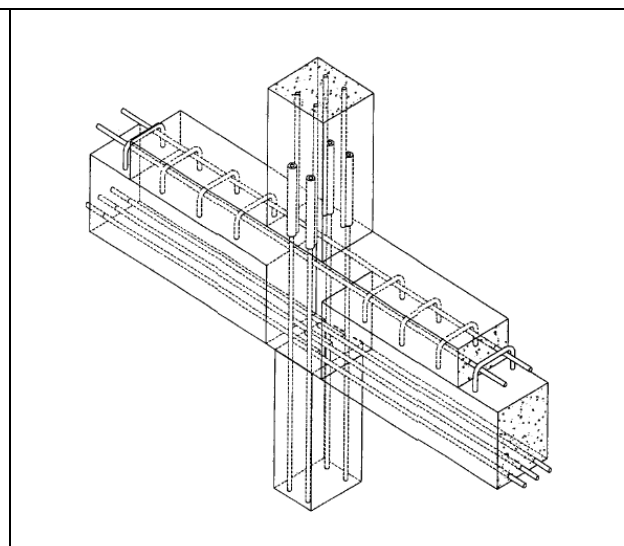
Interrupção de pilar e da viga com ligação por armaduras e betonagem *in situ* (PCI, 1999)
